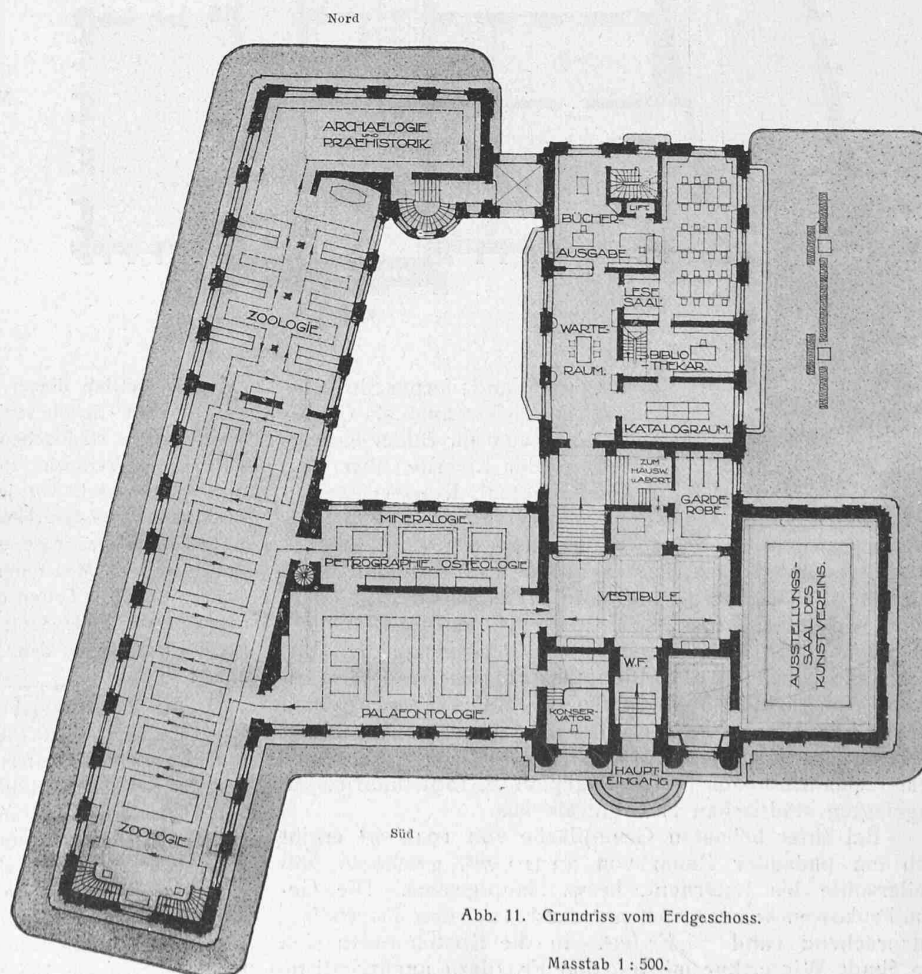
Grundriss vom Erdgeschoss.
